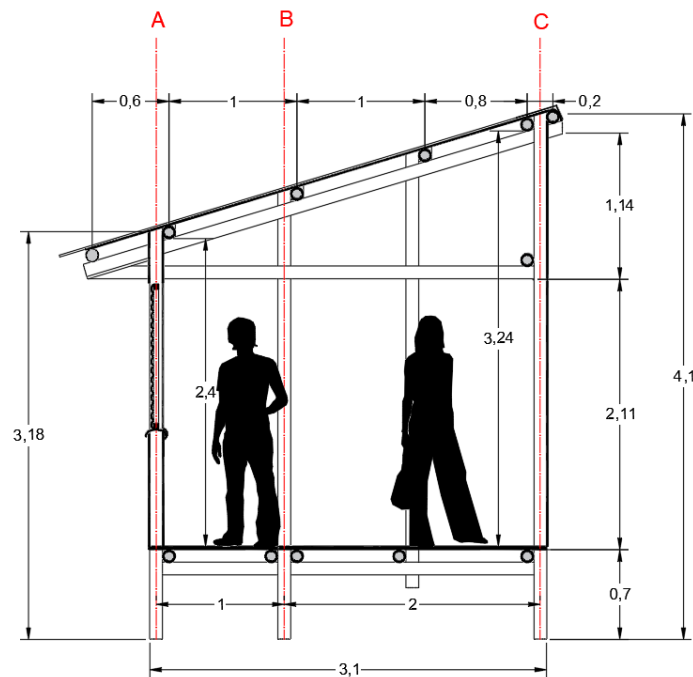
Sección arquitectónica de la vivienda de emergencia. Fuente: Elaboración Propia.
